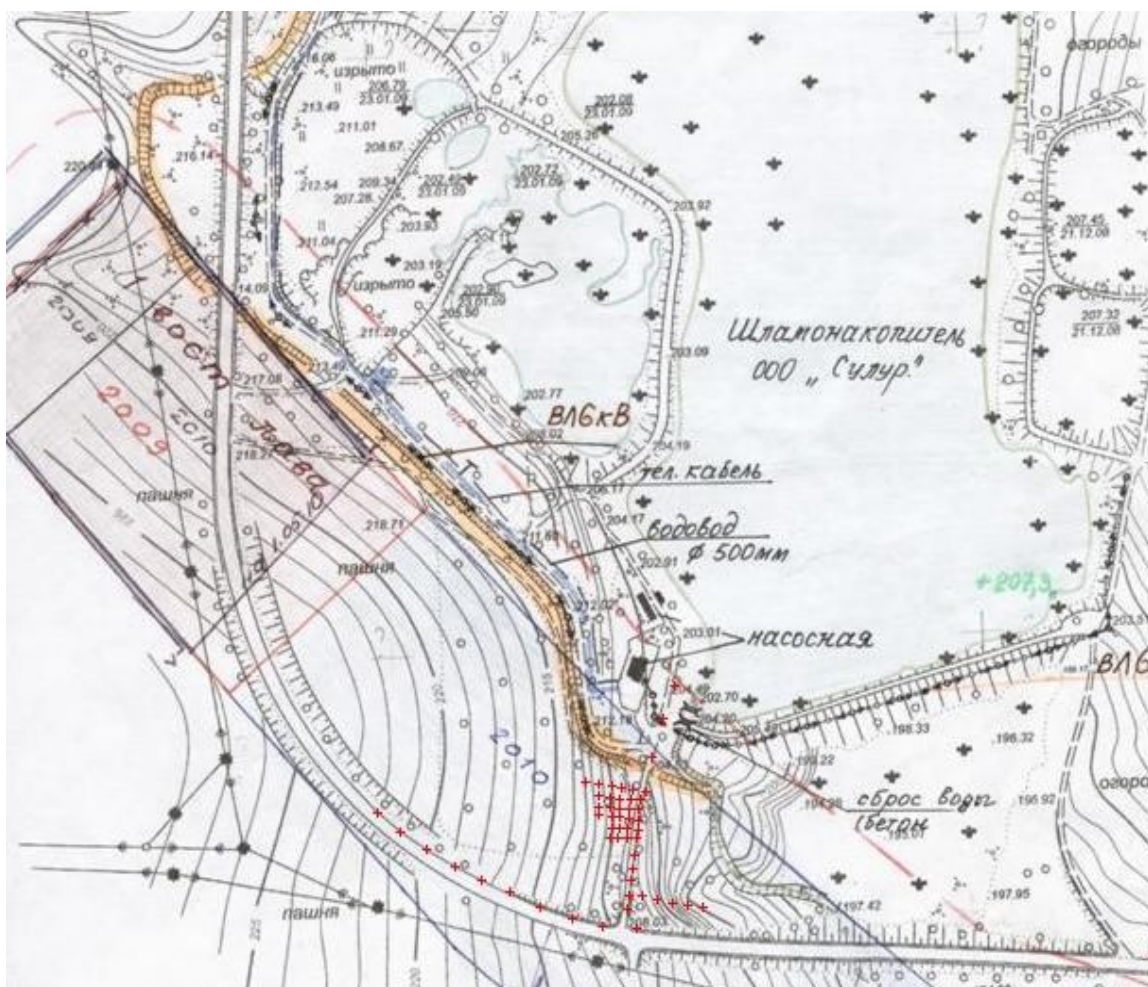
Выкопировка с плана поверхности со схемой расположения реперов
